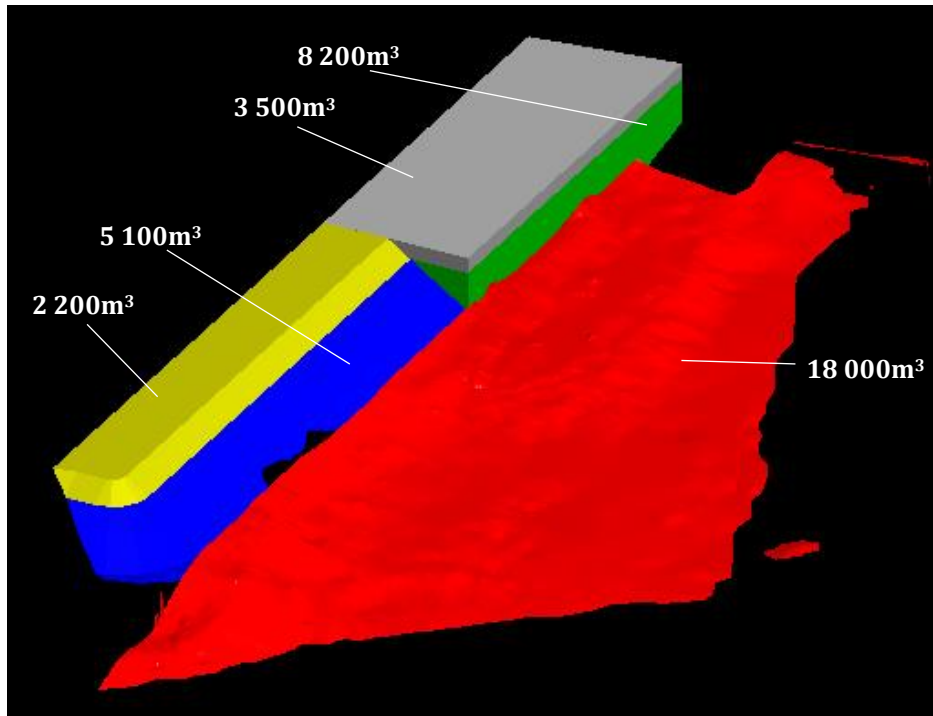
Mudring i indre deler av havnebassenget, planum -13.24 m.
